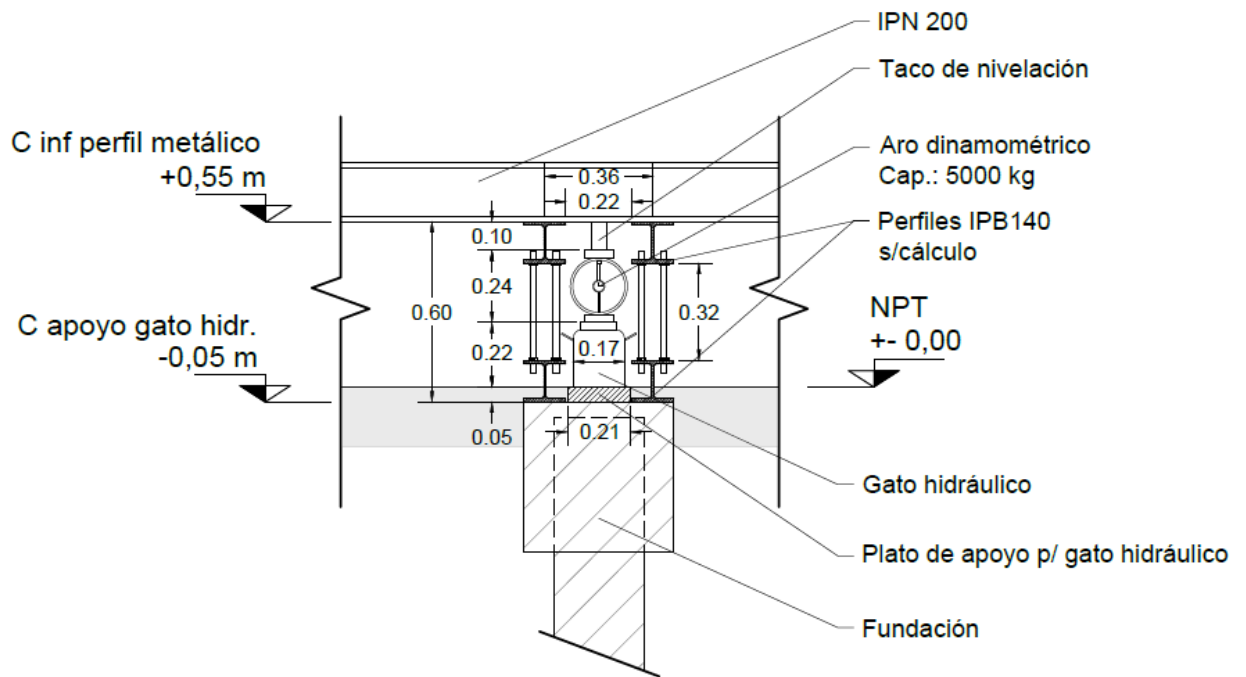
Detalle de aplicación de precarga sobre cabezal y pilotes
